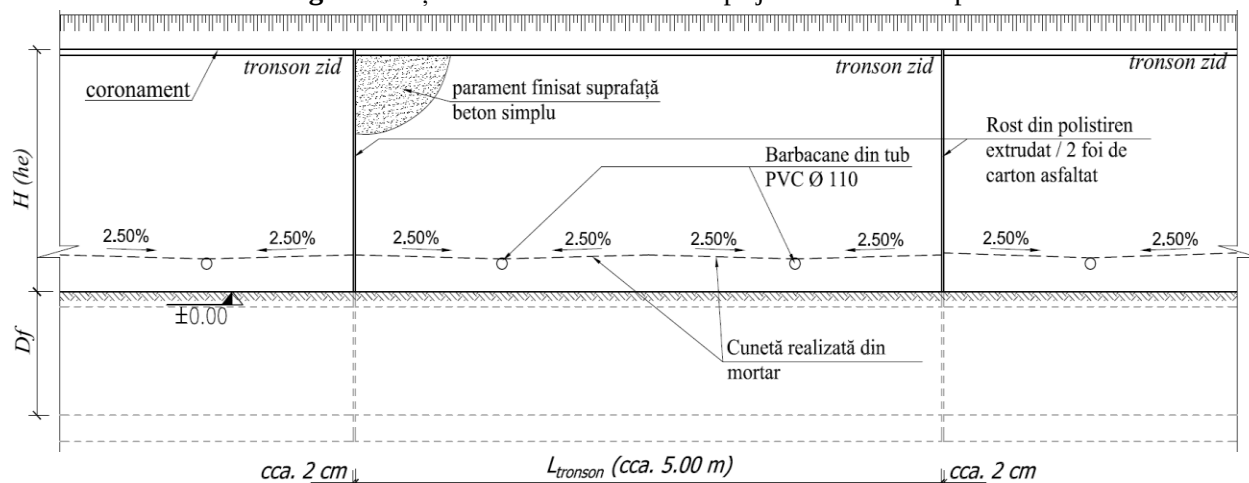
Vedere longitudinală zid de sprijin din beton simplu
